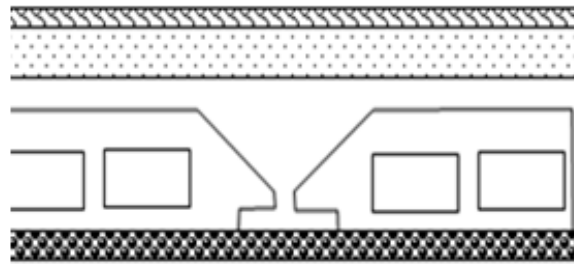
Section transversale d'un plancher à corps creux d'étage courant.
